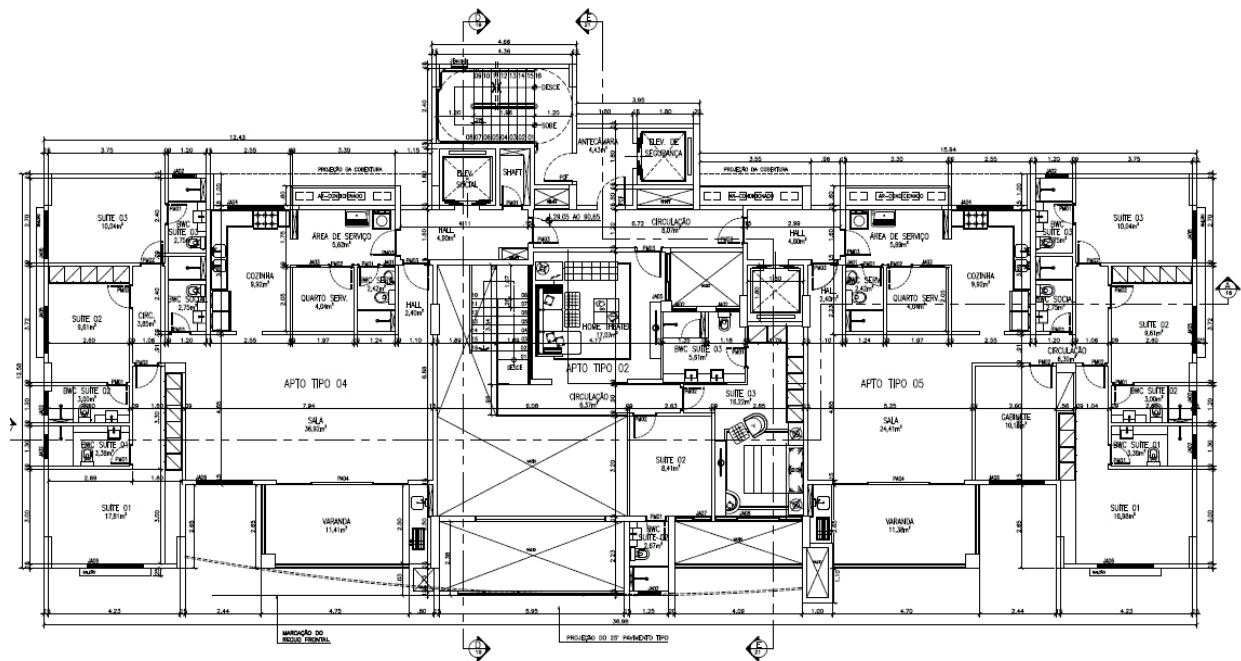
Planta do pavimento tipo do projeto 02 do Escritório 01
